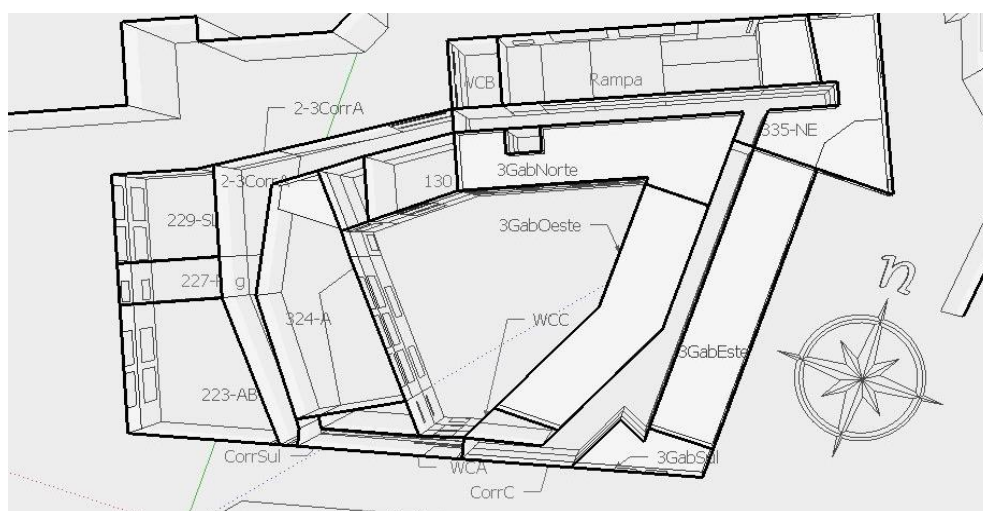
Planta do modelo construído com divisão das zonas térmicas
